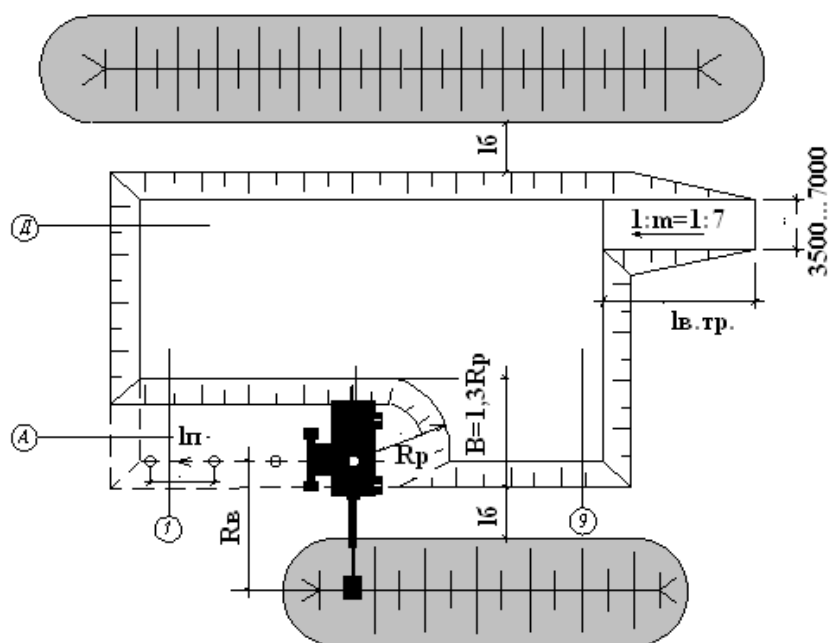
Схемы боковых проходок при устройстве котлована с разработкой грунта навывмет
